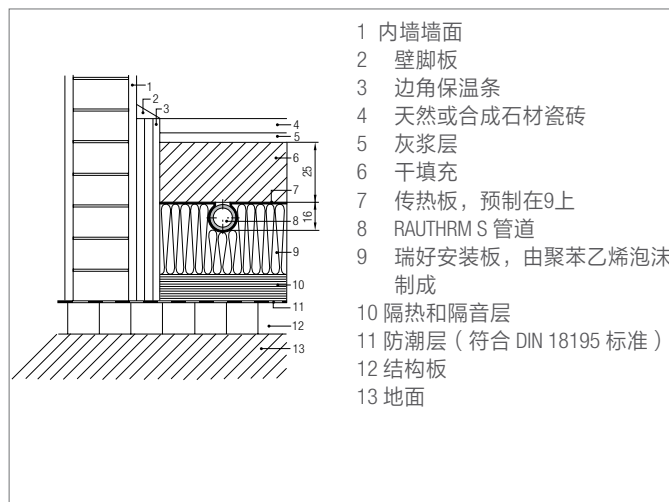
安装 RAUTHERM S 管道的瑞好基板 TS-14 系统
